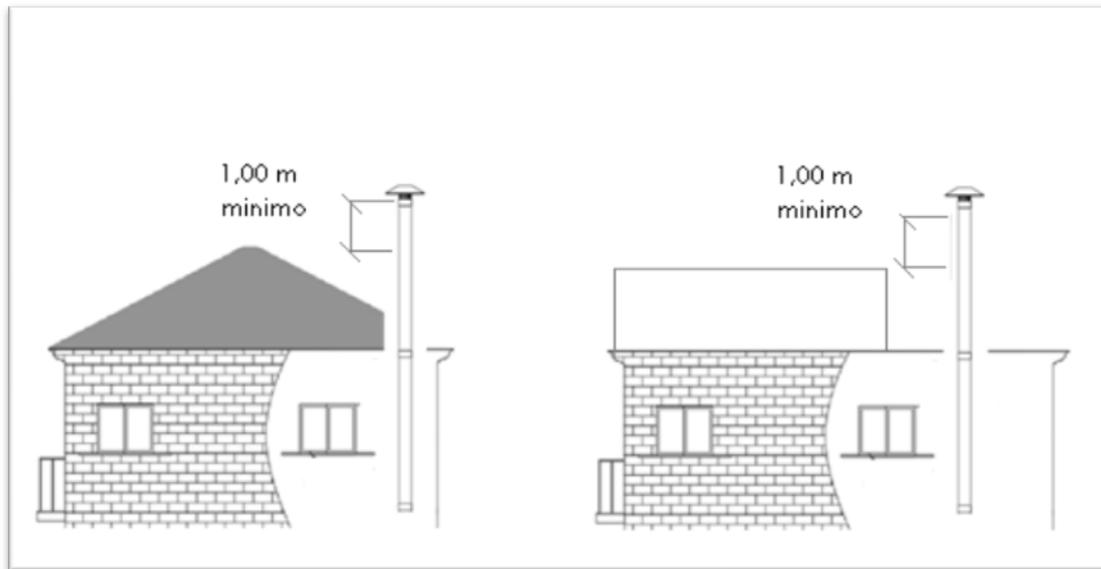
Altura correcta terminales de chimenea con cubierta en pendiente y plana
